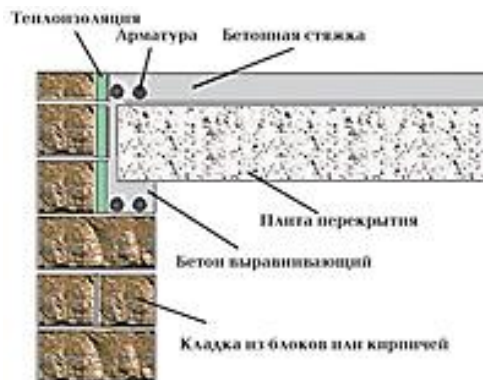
Схема безбалочного перекрытия малоэтажного здания
